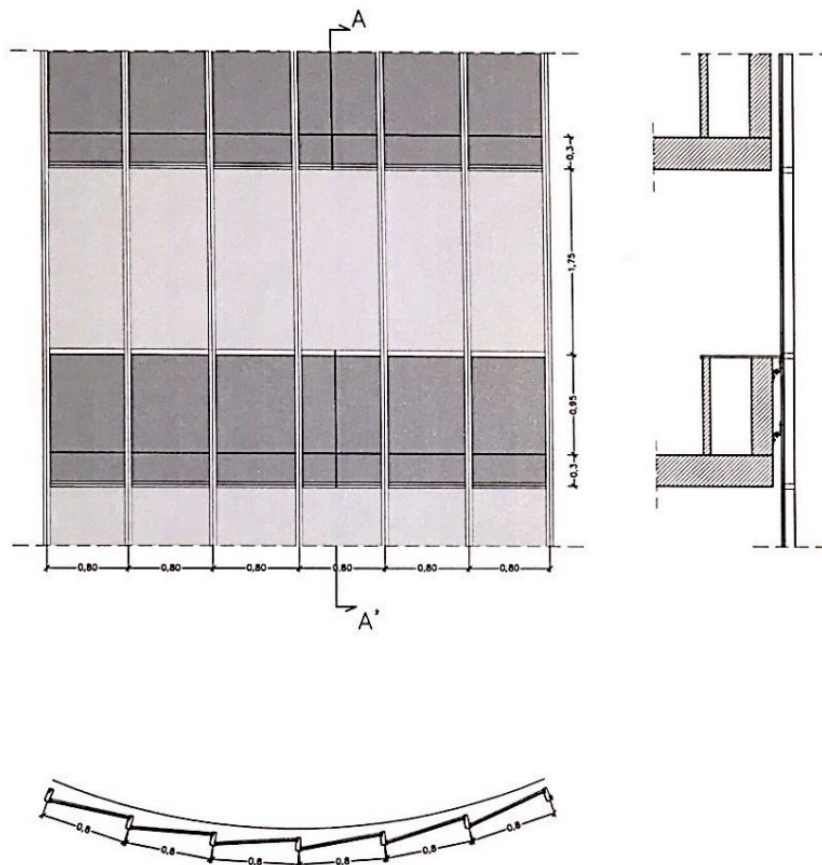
Alzado, sección y planta del muro cortina. Fuente: Corbetta y Parés 2005.
